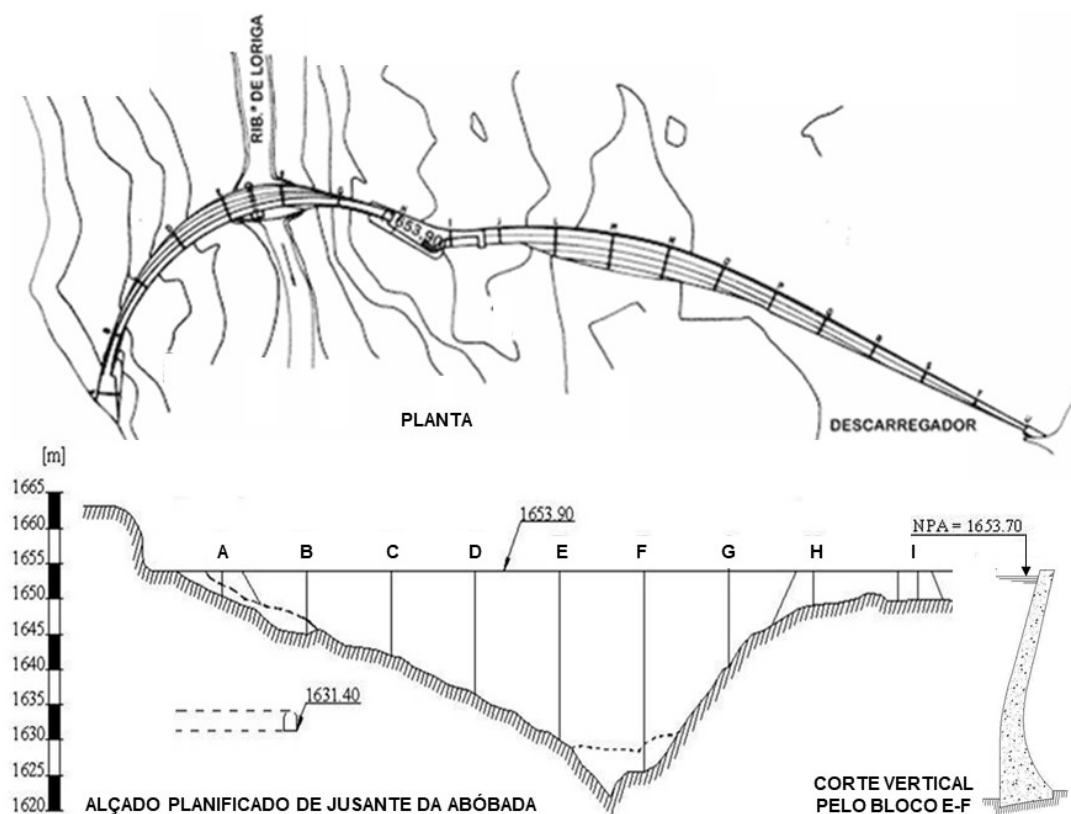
Barragem do Covão do Meio. Planta, alçado planificado de jusante da abóbada e corte pelo bloco mais alto da abóbada (adaptado de (LNEC, 2006))
